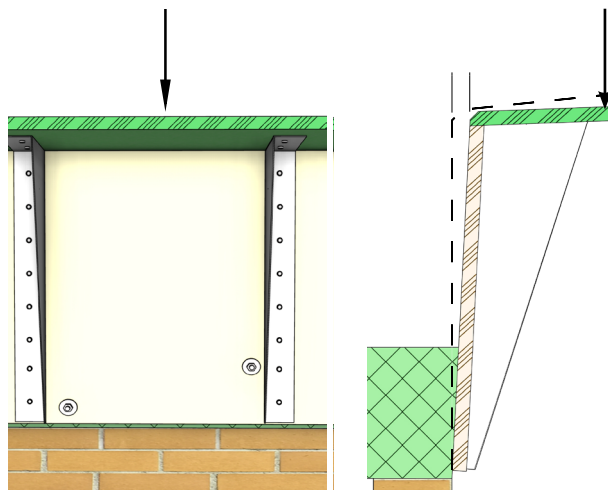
Stille des ungünstigsten Falles der Dachrandkonstruktion.
